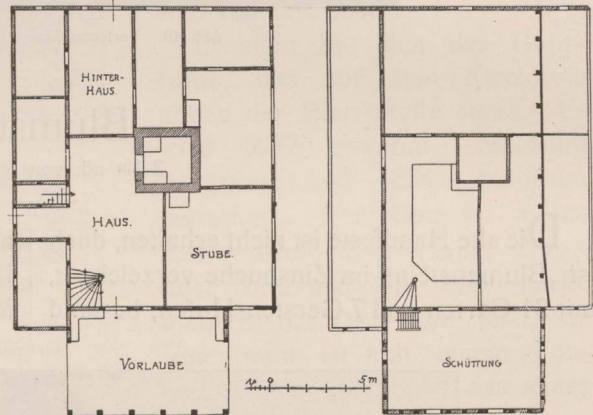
Grundrisse des Erdgeschosses und Obergeschosses
